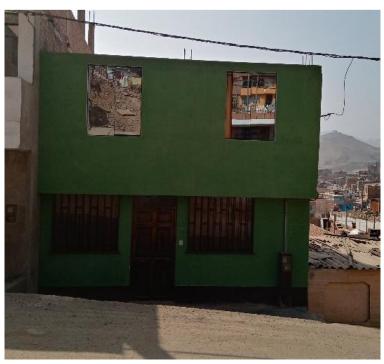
MZ B Lote 18. Vivienda de material noble con techo de losa aligerada.
